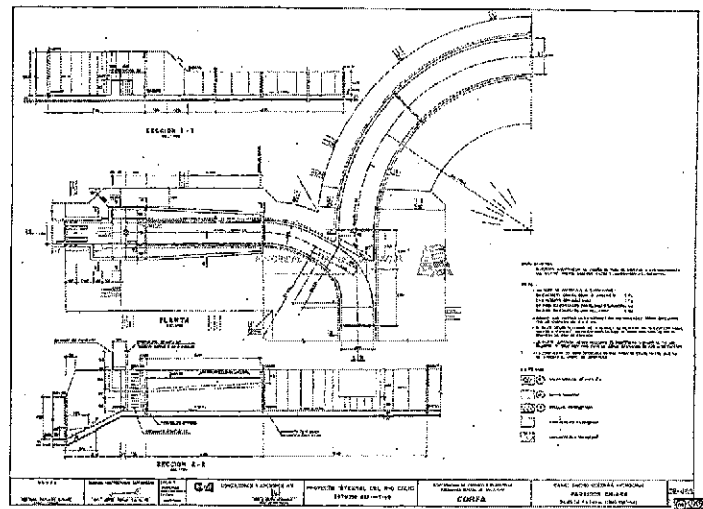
Planta y perfil longitudinal - Plano DE-455, según la fuente [CORFA, 1984, página 75]
